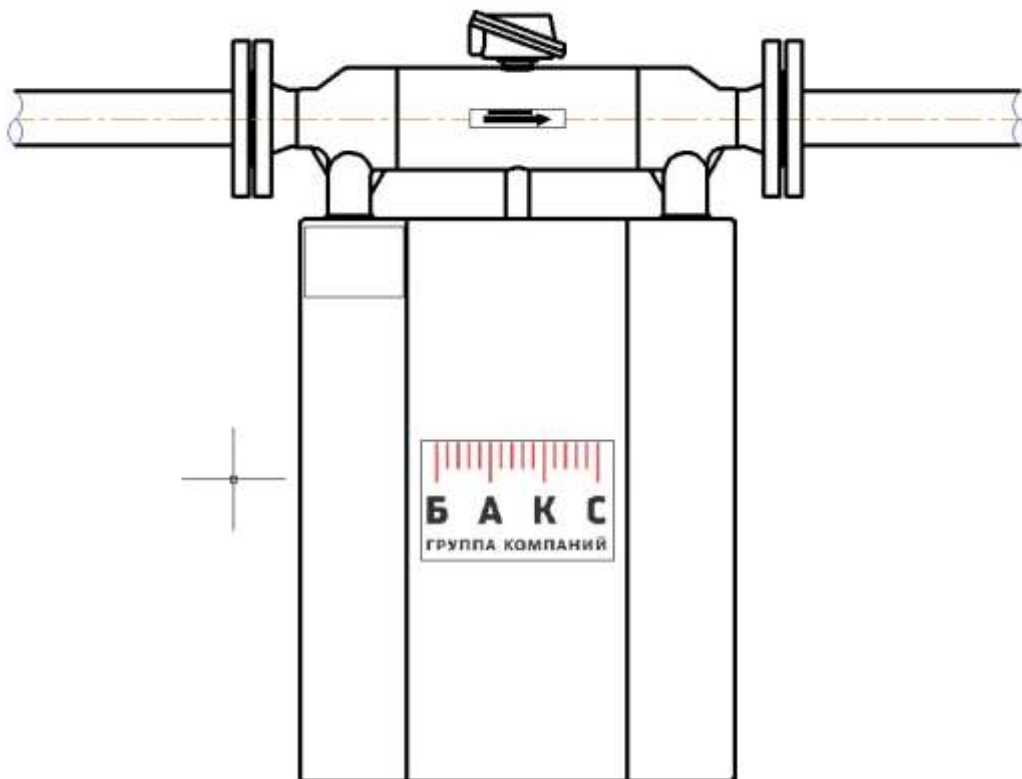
Монтаж расходомера в горизонтальный участок трубопровода
